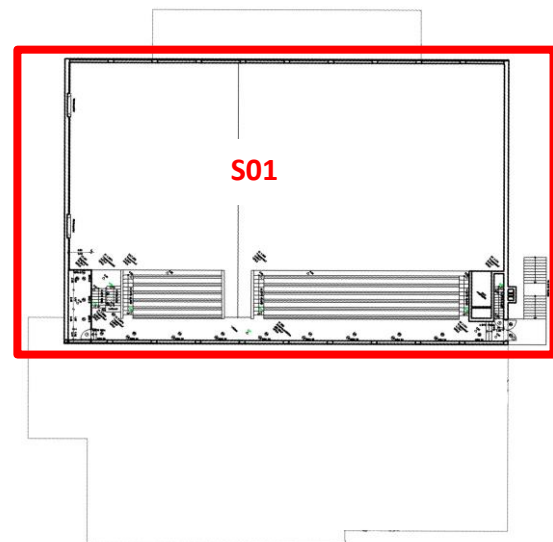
Grundriss 1. Obergeschoss Sporthalle
